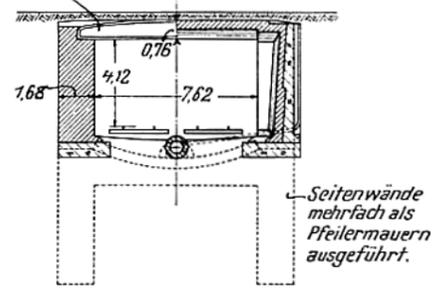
Tunnel (covered way) mit Stein-Eisen-Decke.
